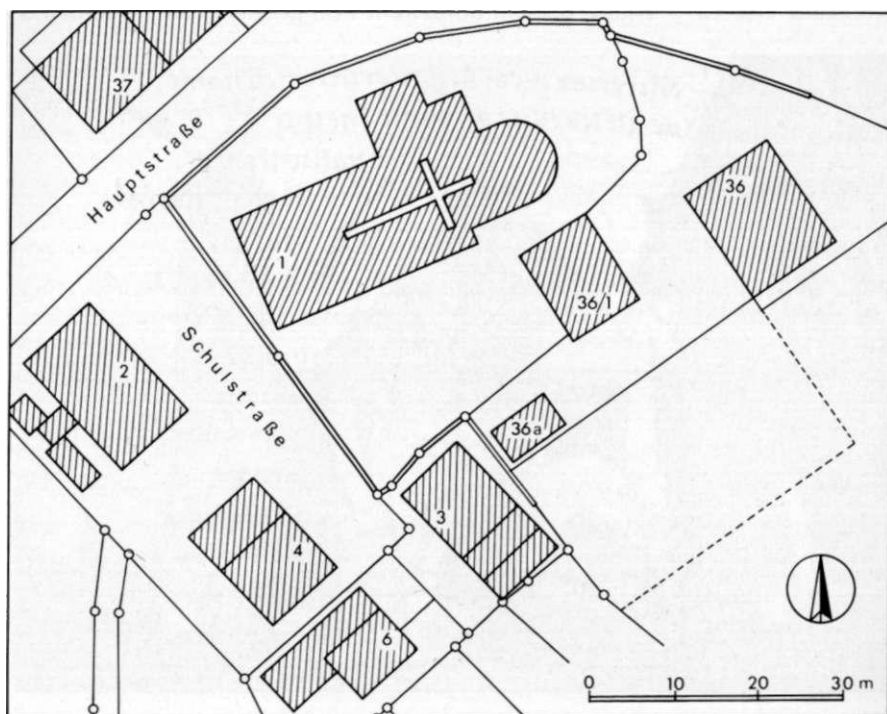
Aldingen. Lageplan der Kirche St. Mauritius.
